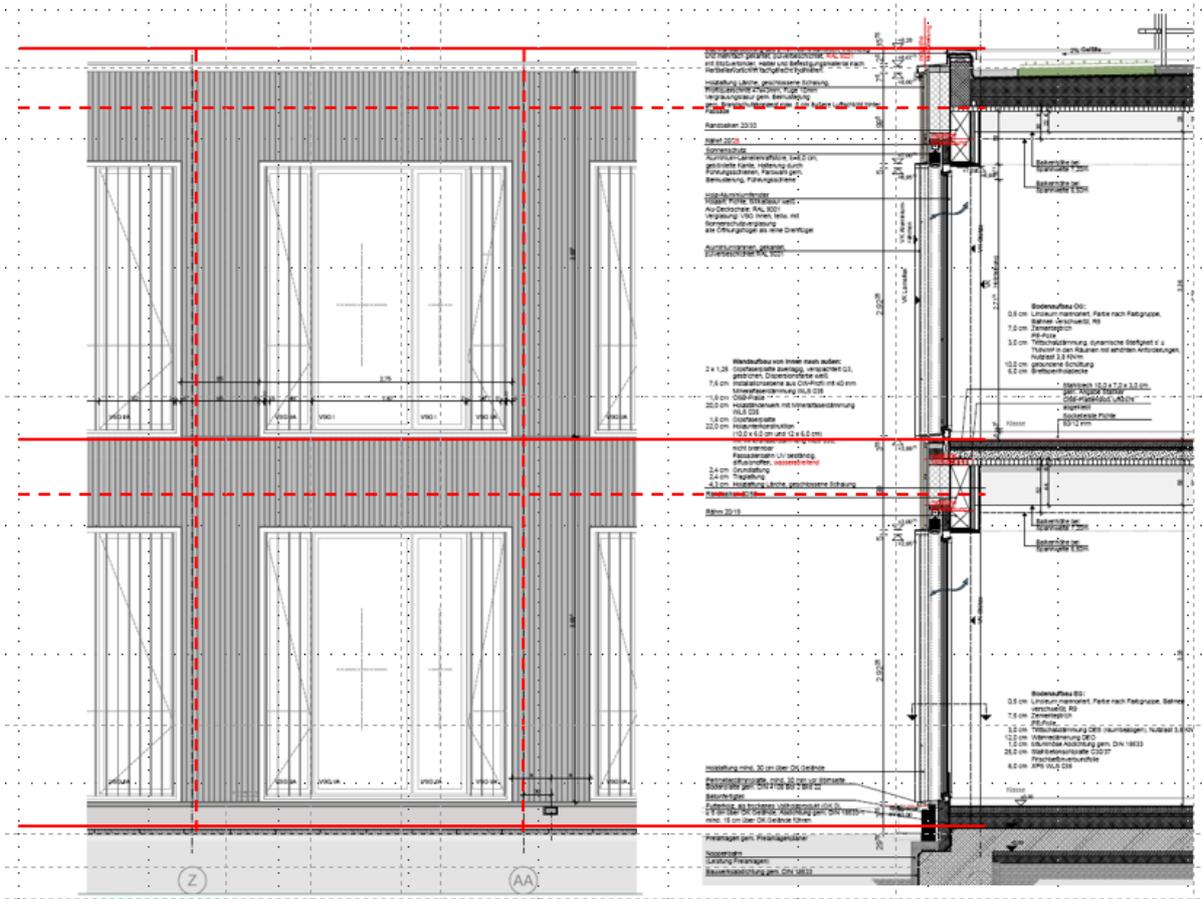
Elementierung der Fassade von Haupt- und Lernhaus (Ausschnitt)
